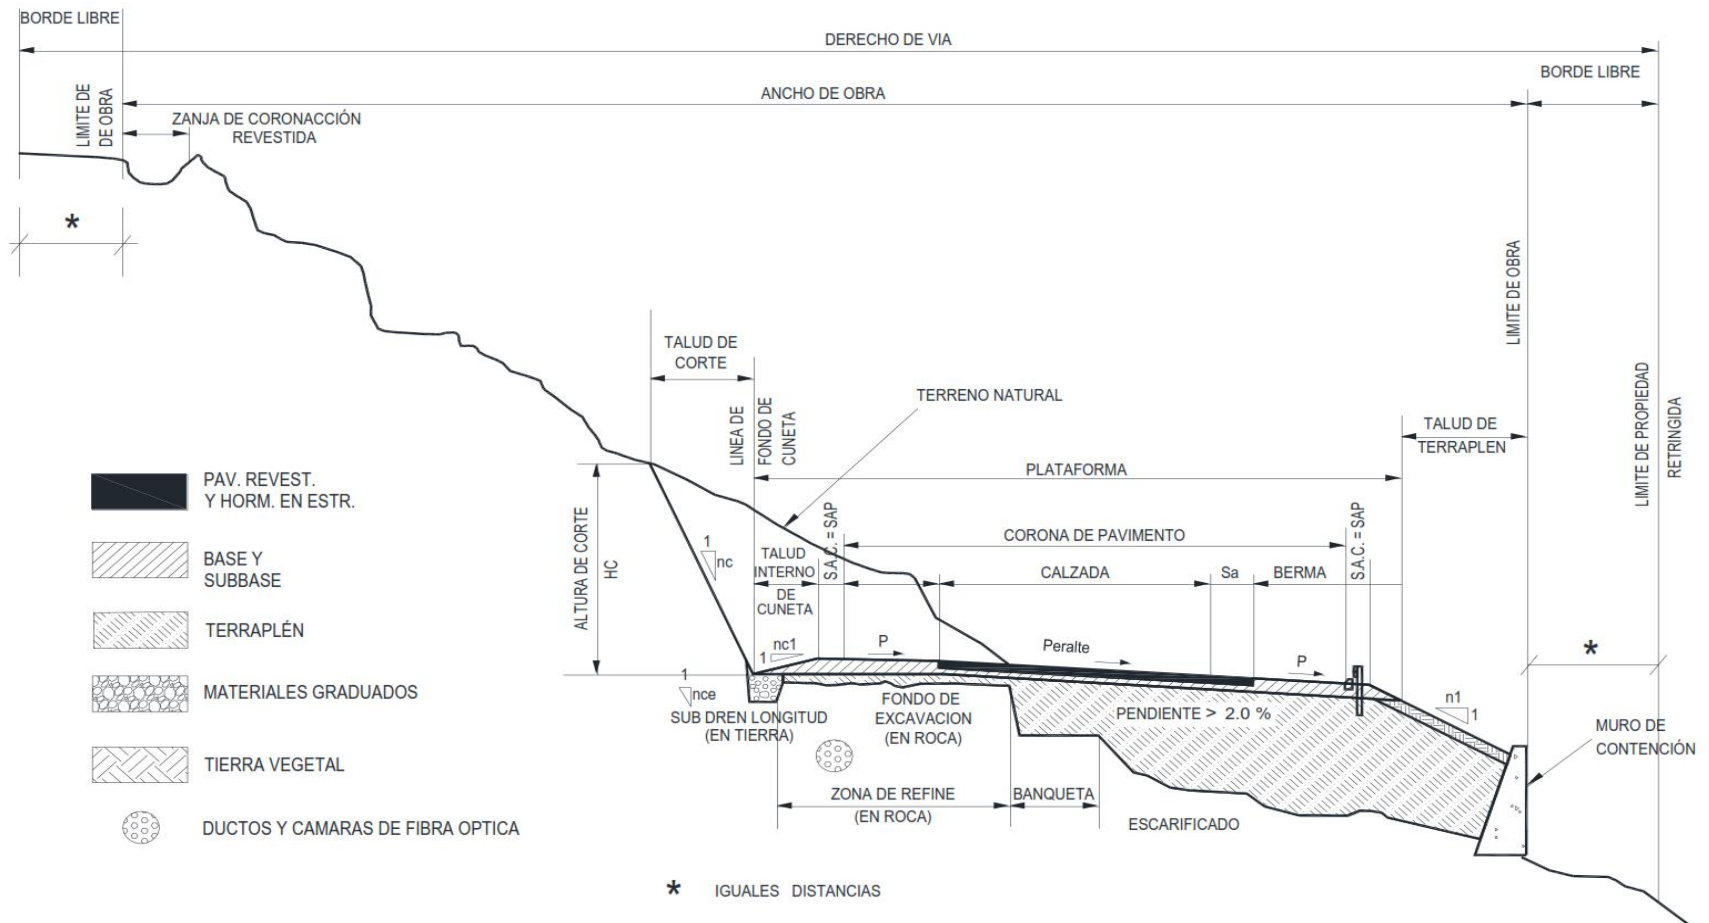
Sección transversal típica con calzada de dos carriles en zona rural
